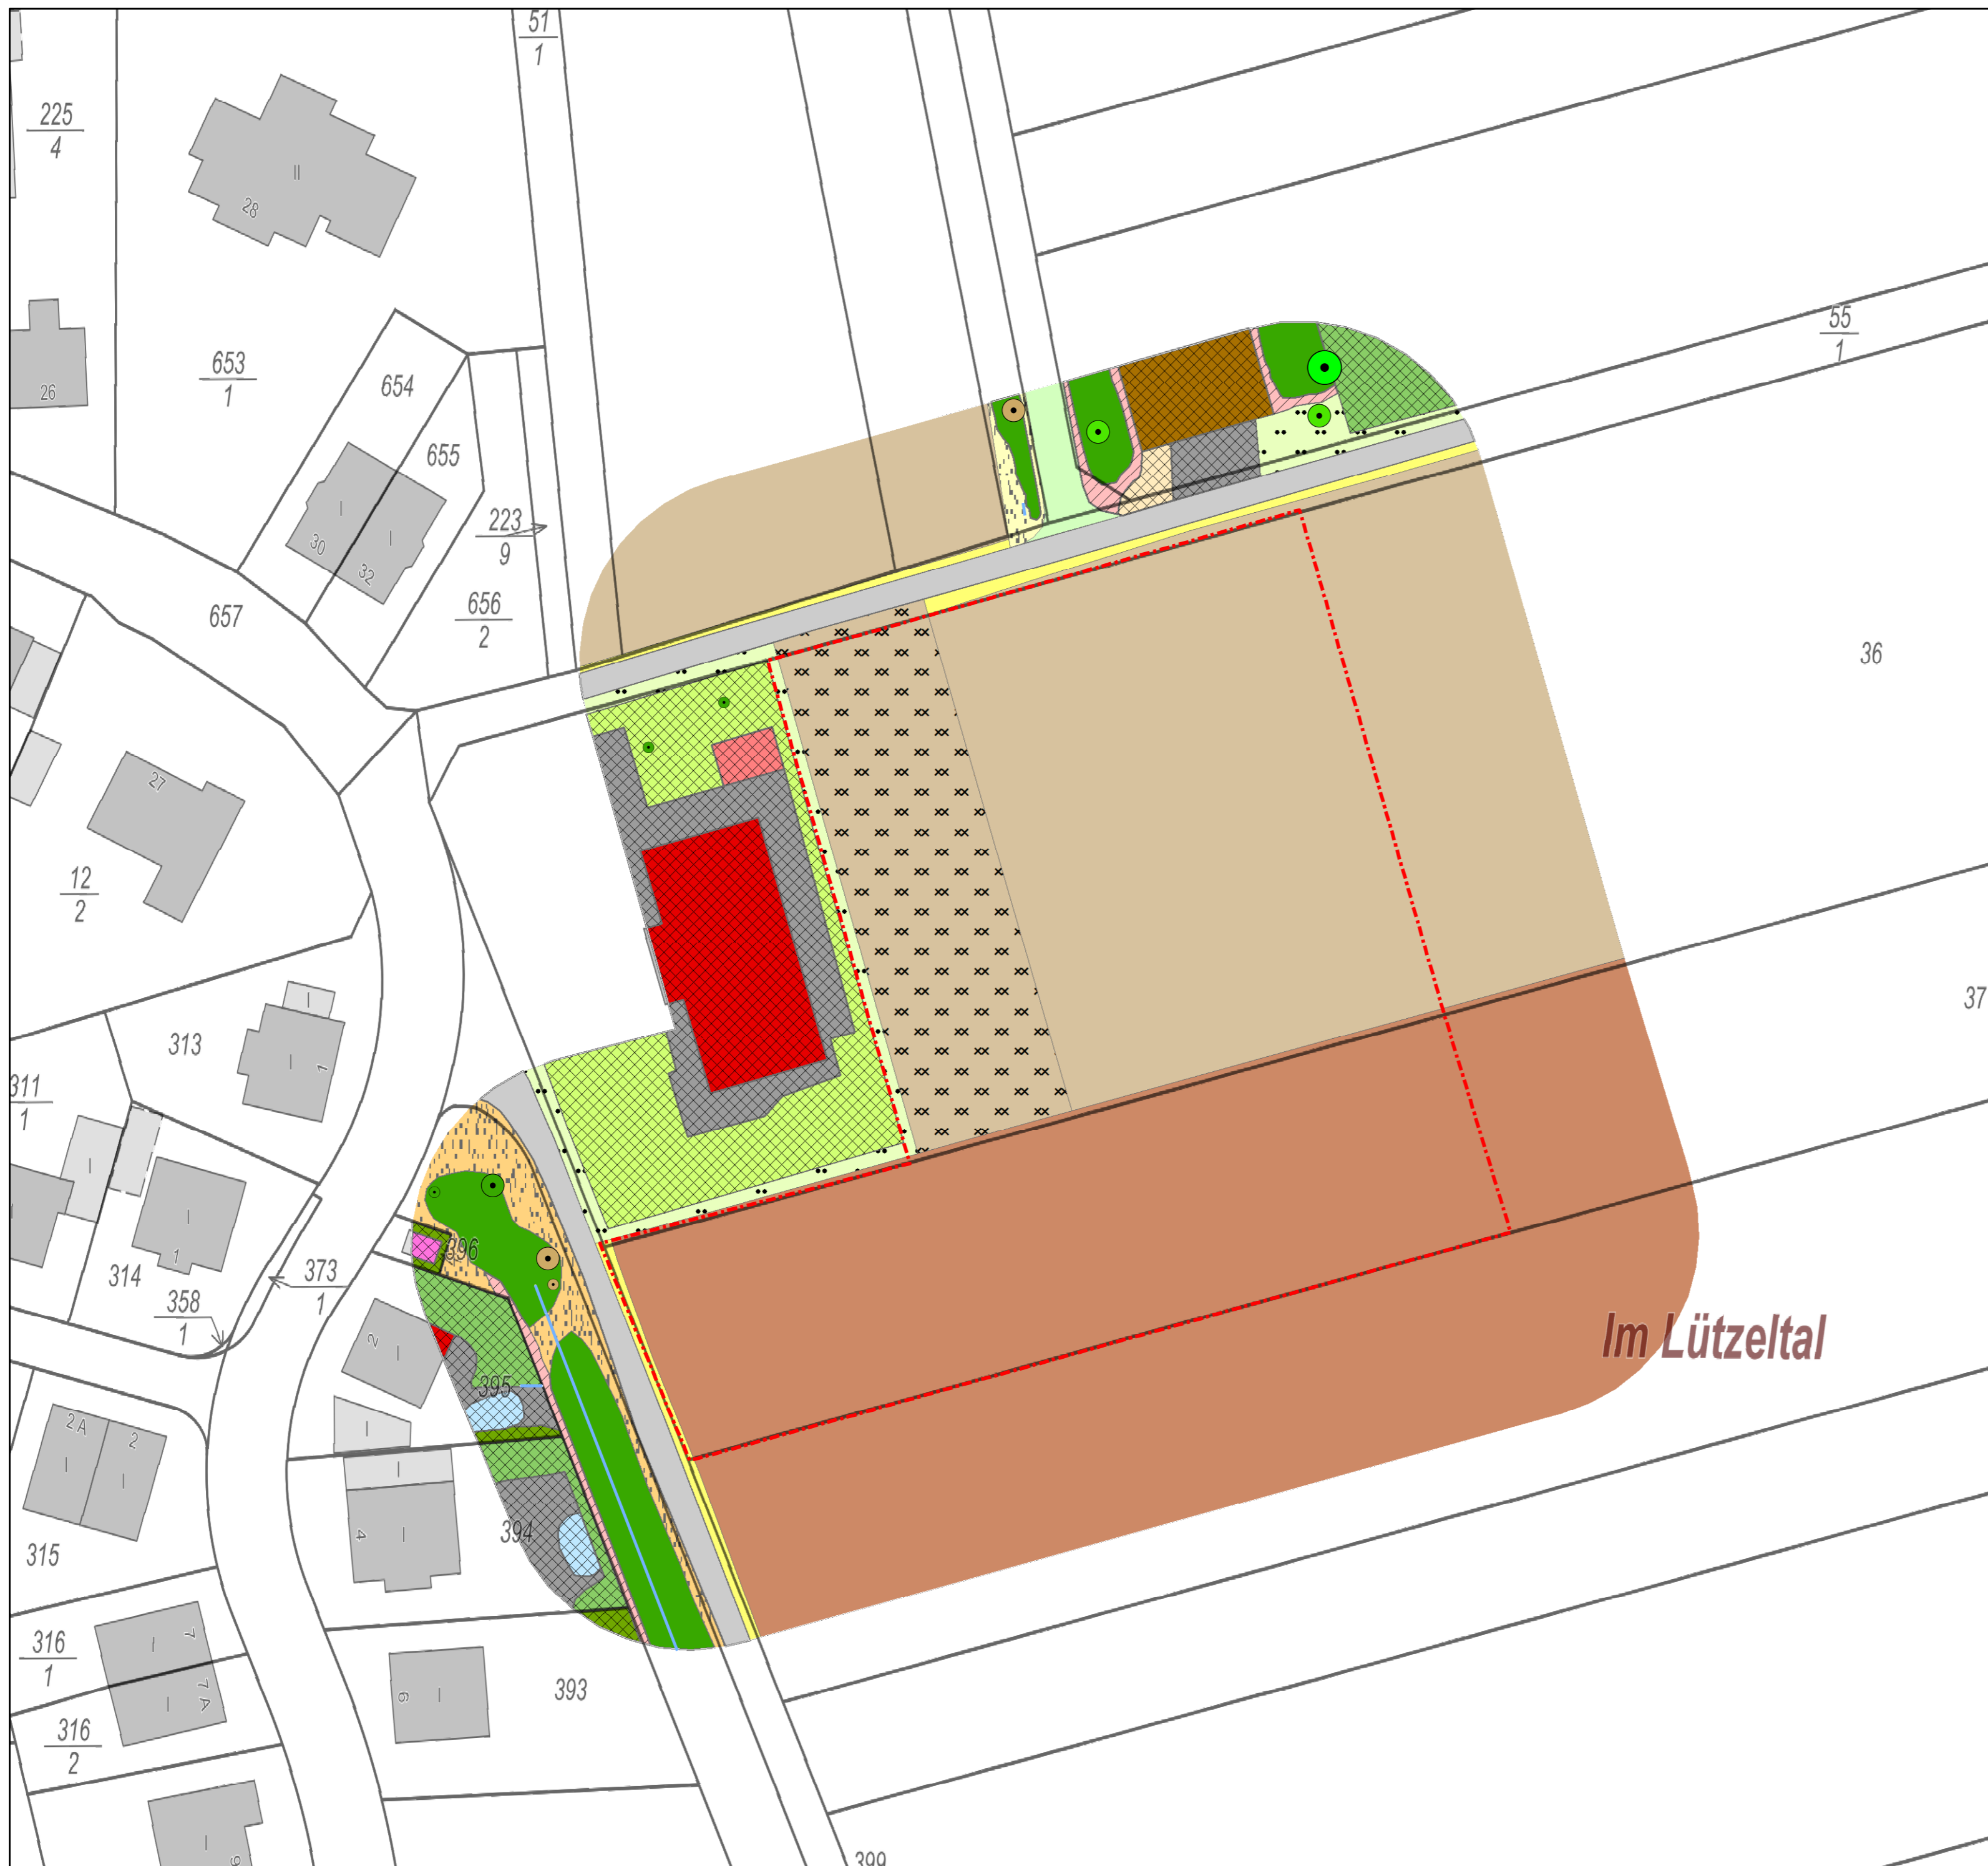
Im Westen schließt sich an die Planfläche ein bestehendes Wohnhaus an
